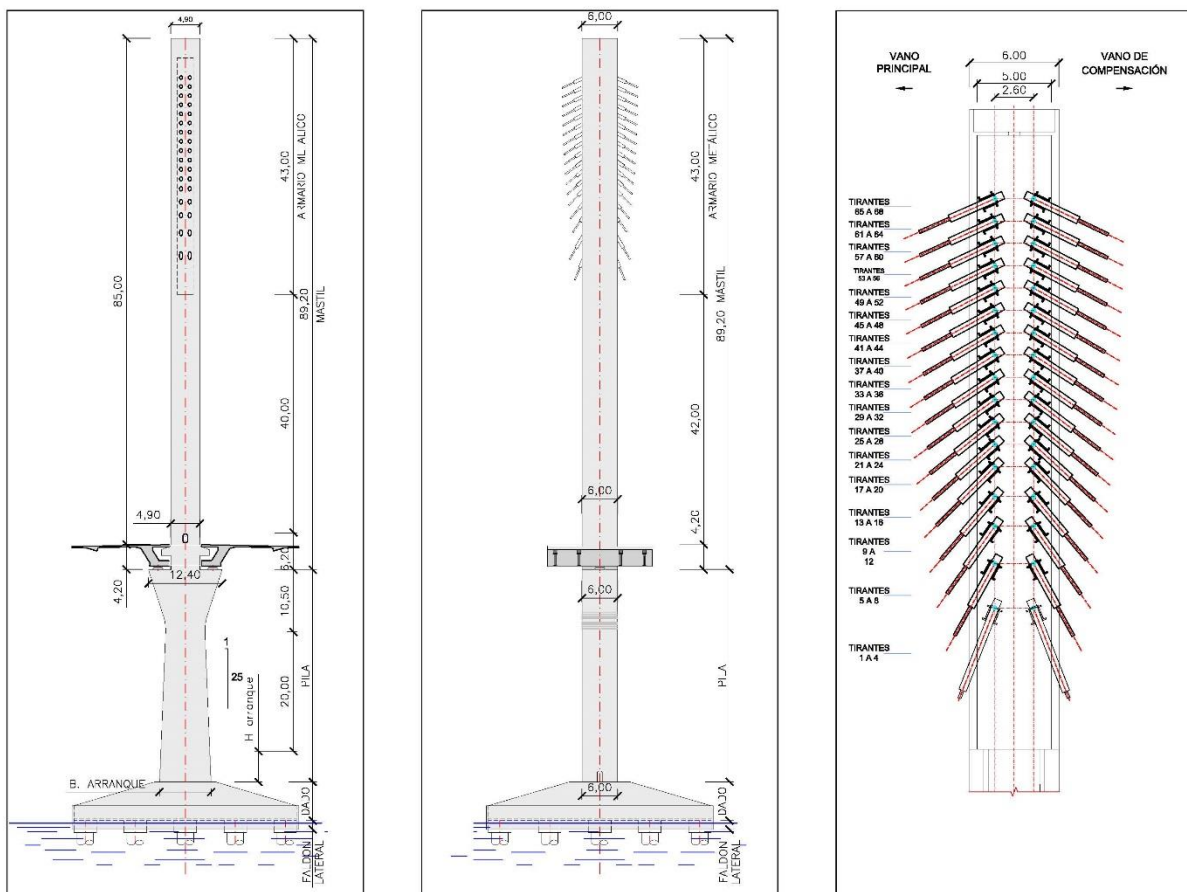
Alzado longitudinal y transversal de los pilonos, y detalle de anclaje de los tirantes mediante armario metálico
